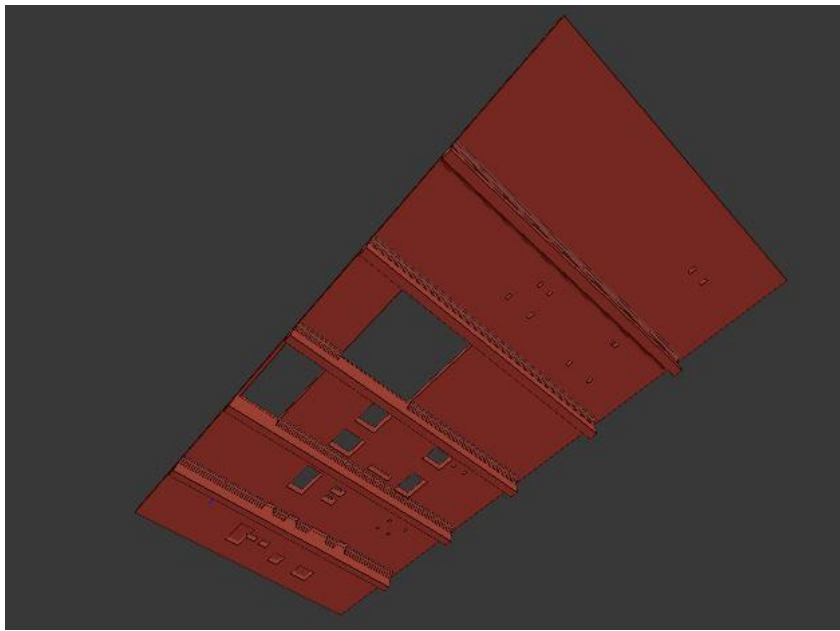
Vista de las perforaciones del techo de la planta primera.
